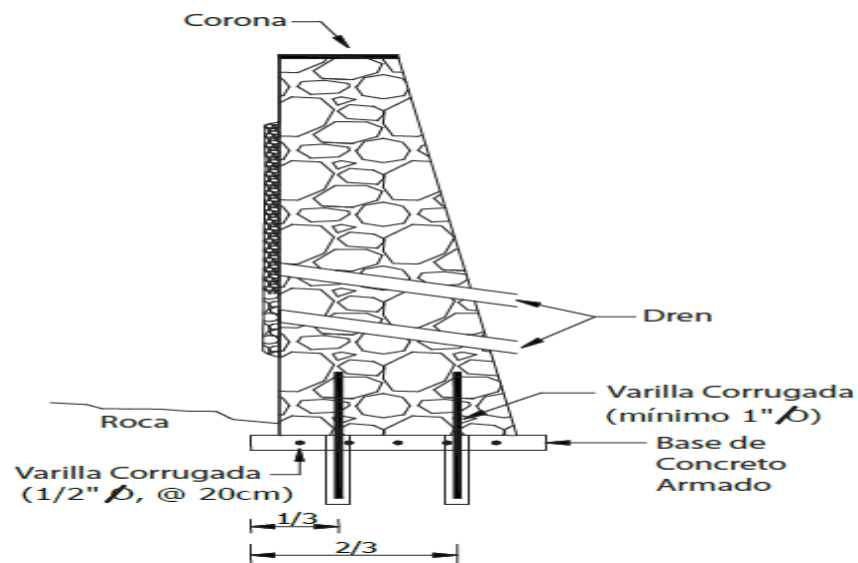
Muro de mampostería con anclaje en suelos de material tipo III y pendientes mayores de 5%.
